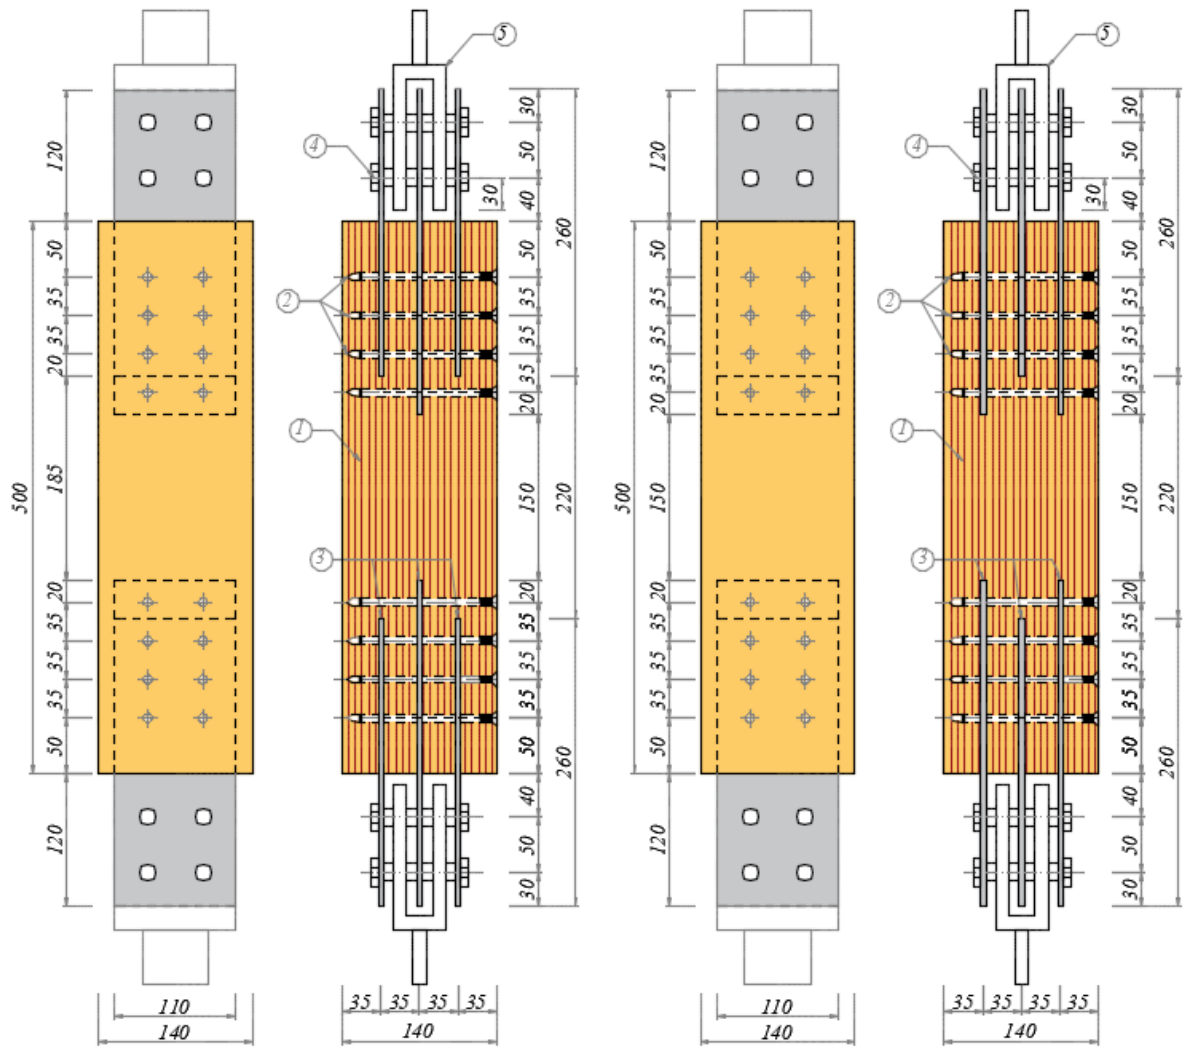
Схема испытания соединений «сталь-дерево» на растяжение:
